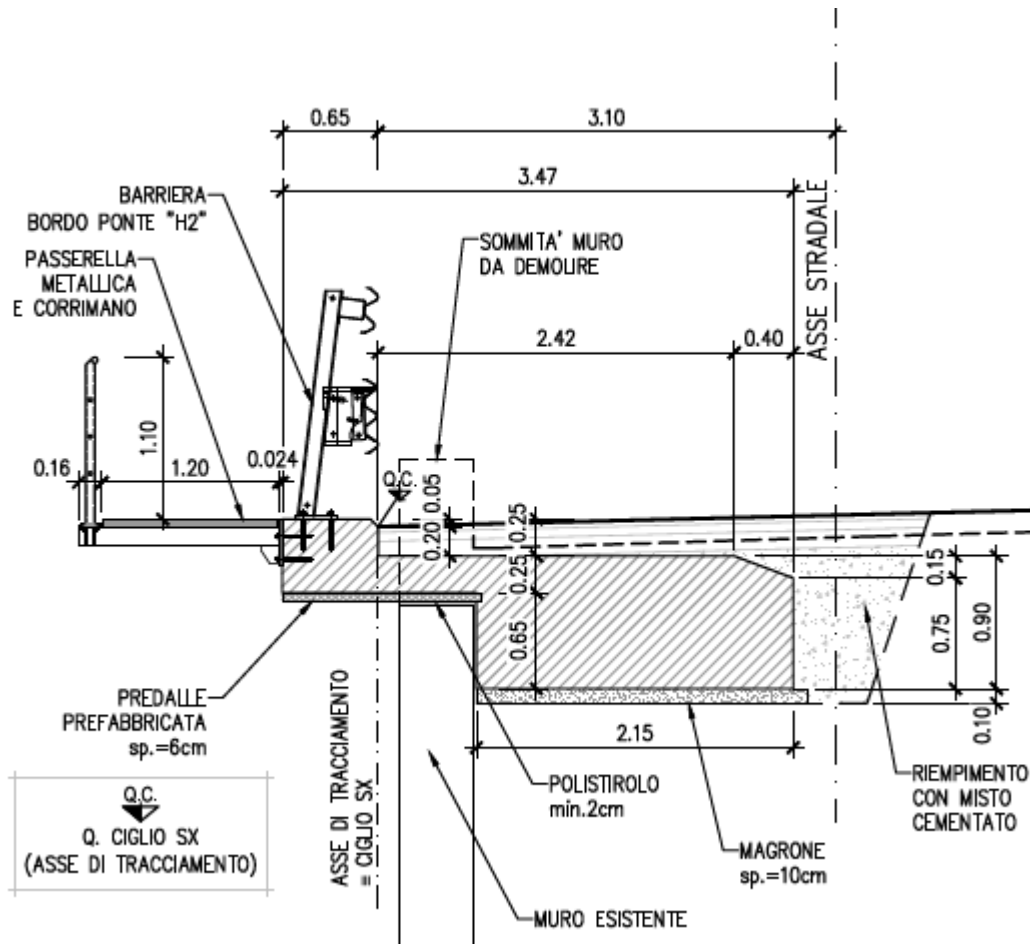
Sezione tipo cordolo tipo 5 con passerella metallica
